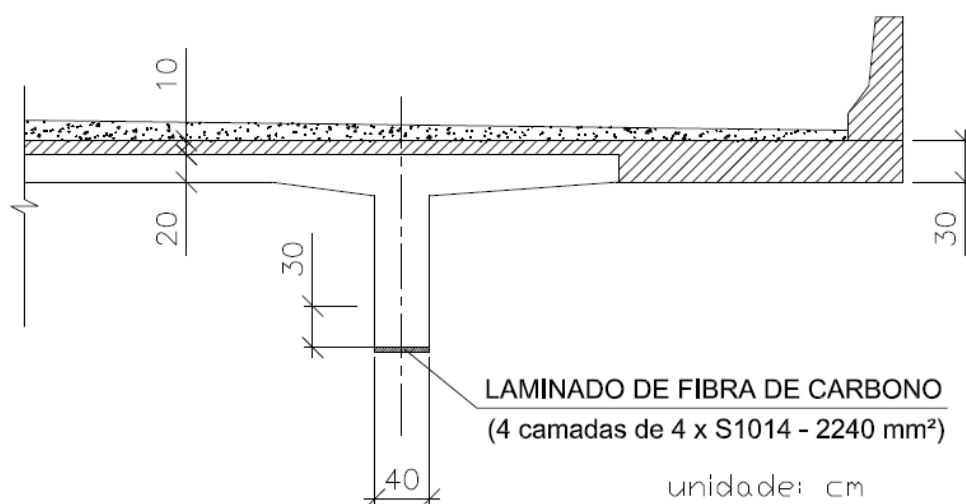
Reforço da viga longitudinal por fixação de laminado de fibra de carbono.
